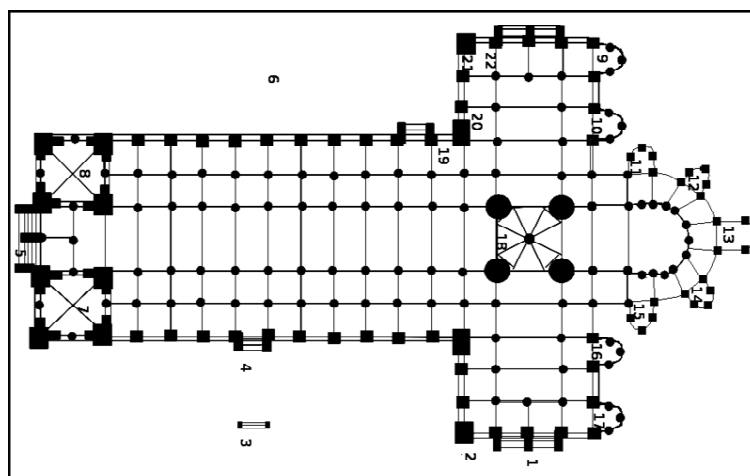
Grundriss, St. Sernin, Toulouse, 1096 geweiht.
